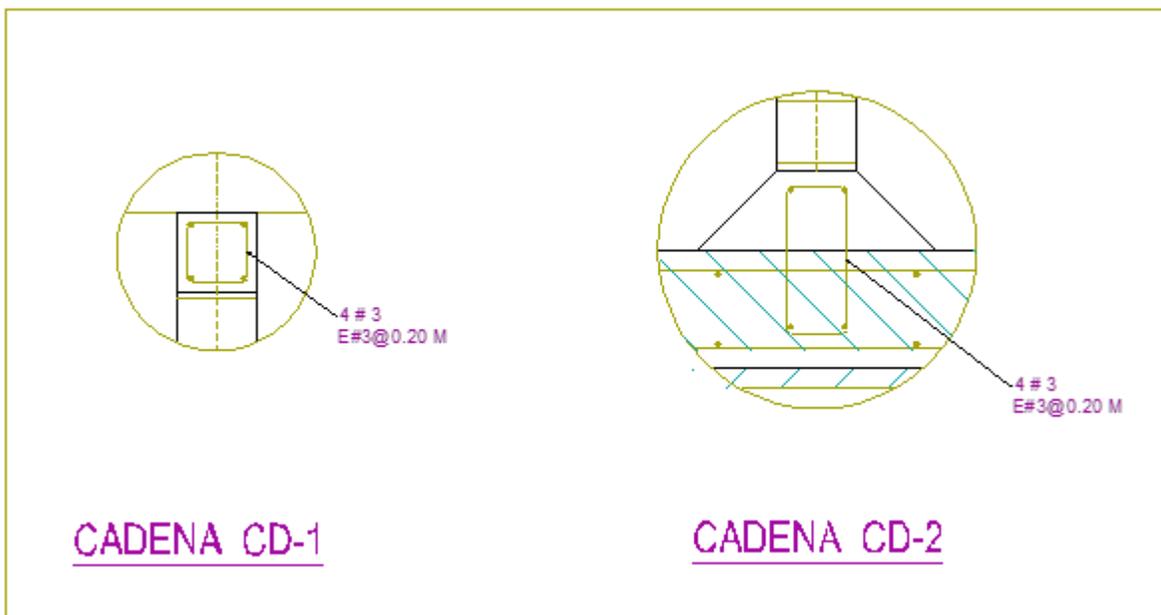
Armado en muro de tanque de contacto de cloro.
